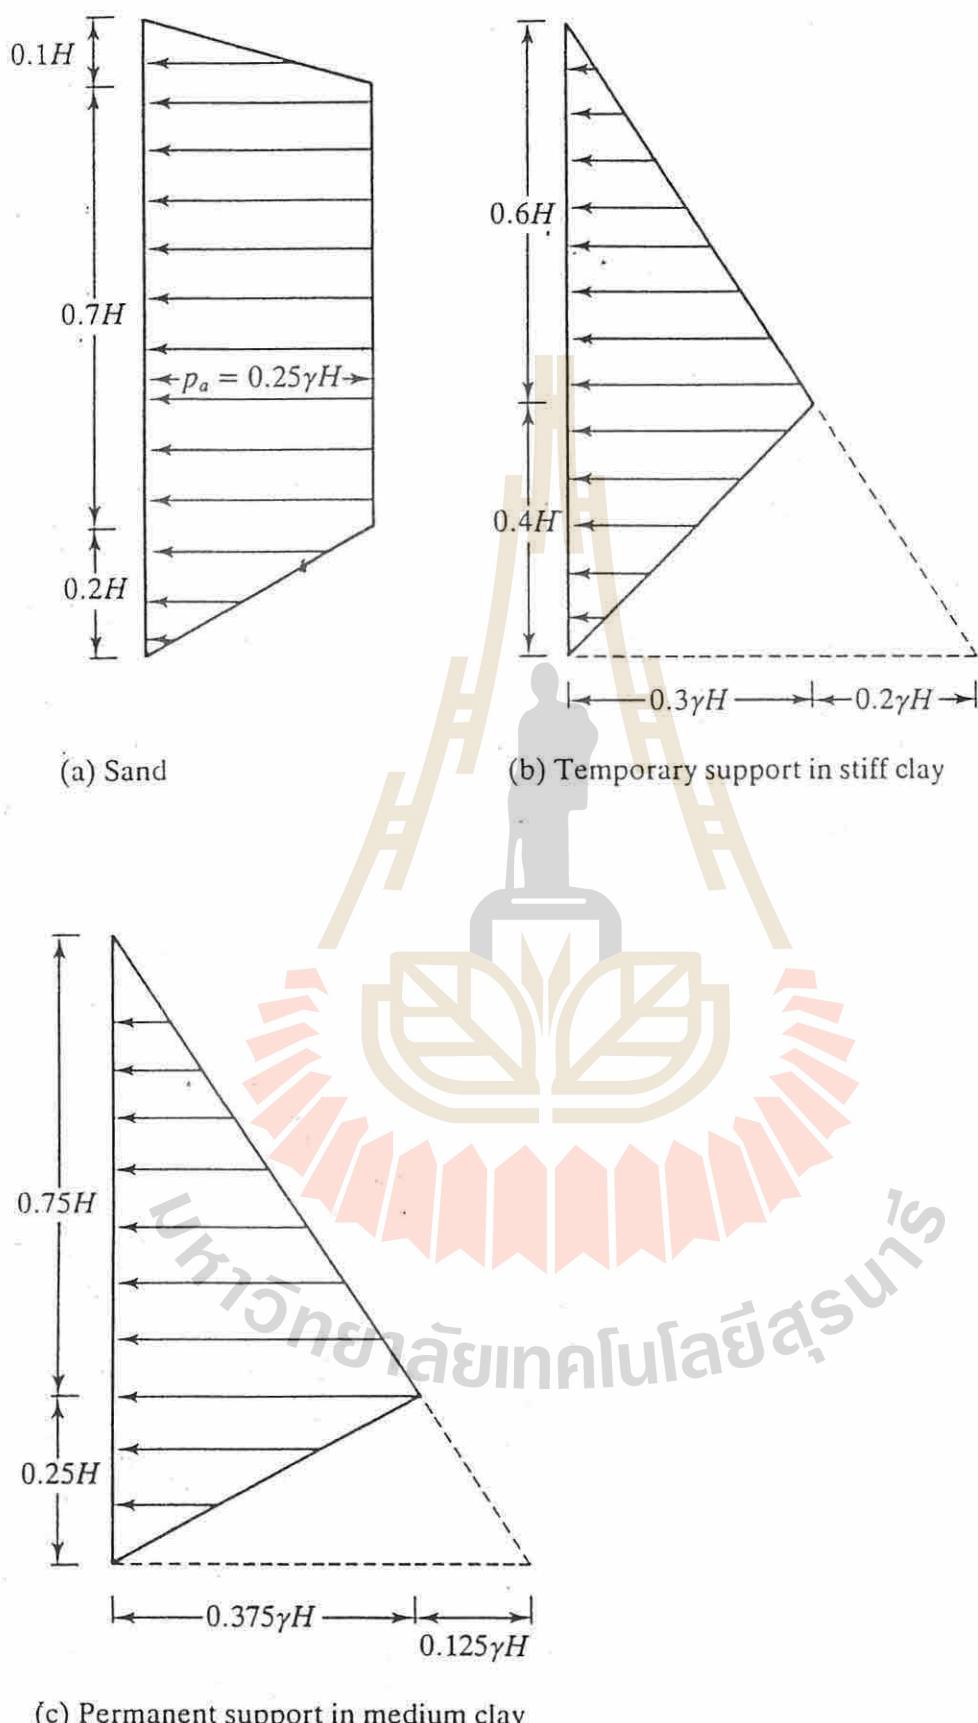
การคำนวณระบบ Sheet Pile แบบ Prace Cut.
